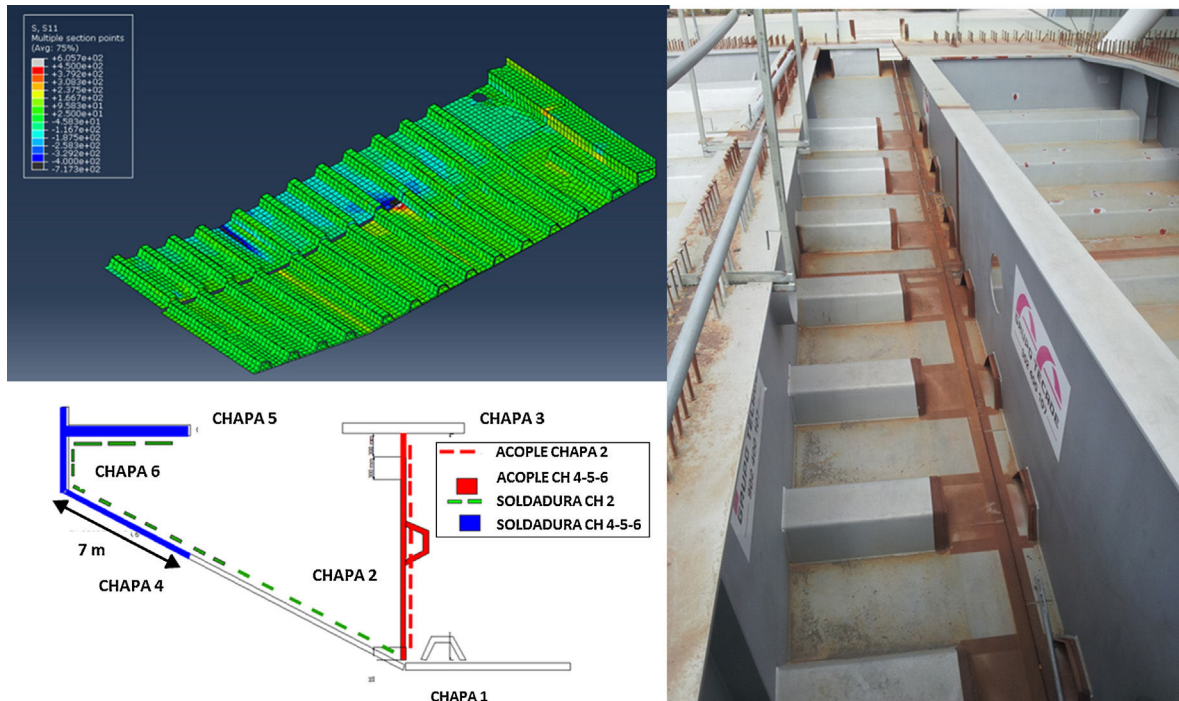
Soldadura parcial para proceder al hormigonado de las juntas de hormigón. Esquema, modelo y soldadura.
